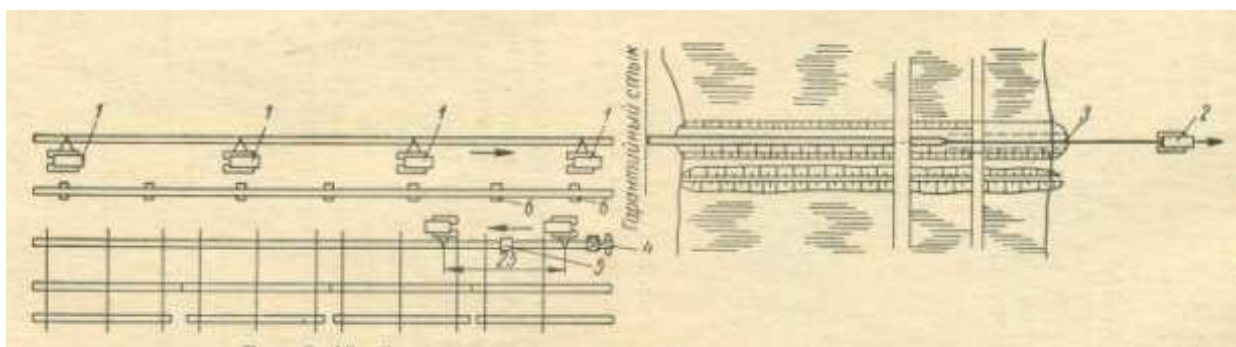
Схема раздельного способа укладки трубопровода сплавом [12]:
